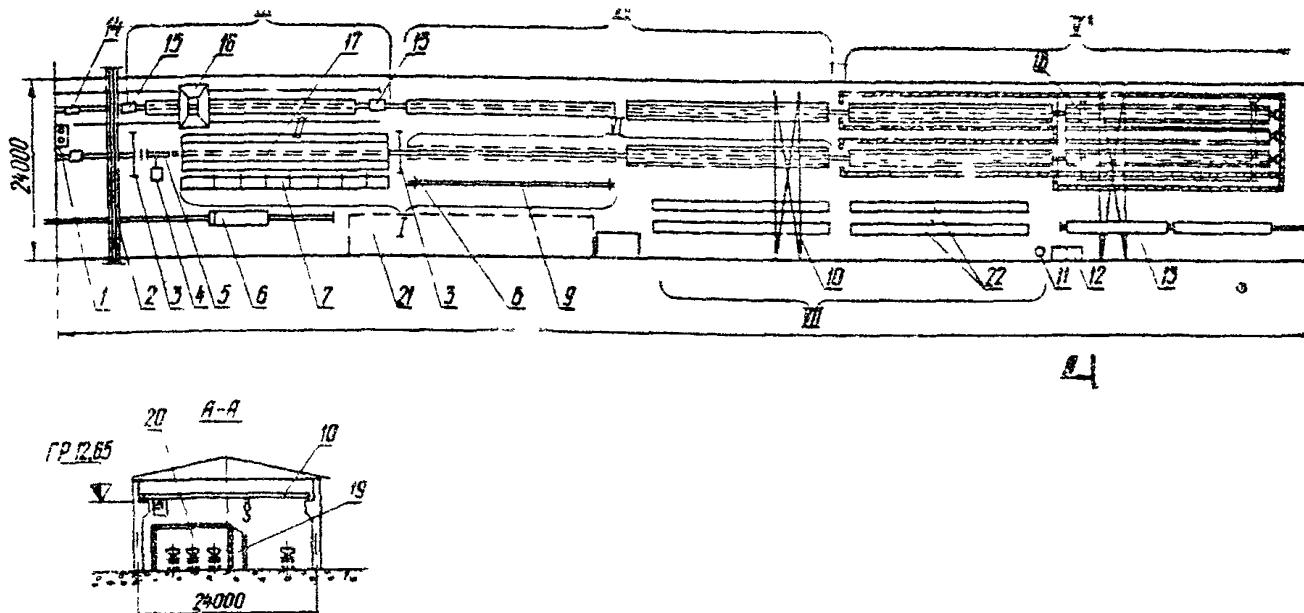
Схема технологической линии: 1 - супергатор для приготовления смазки
